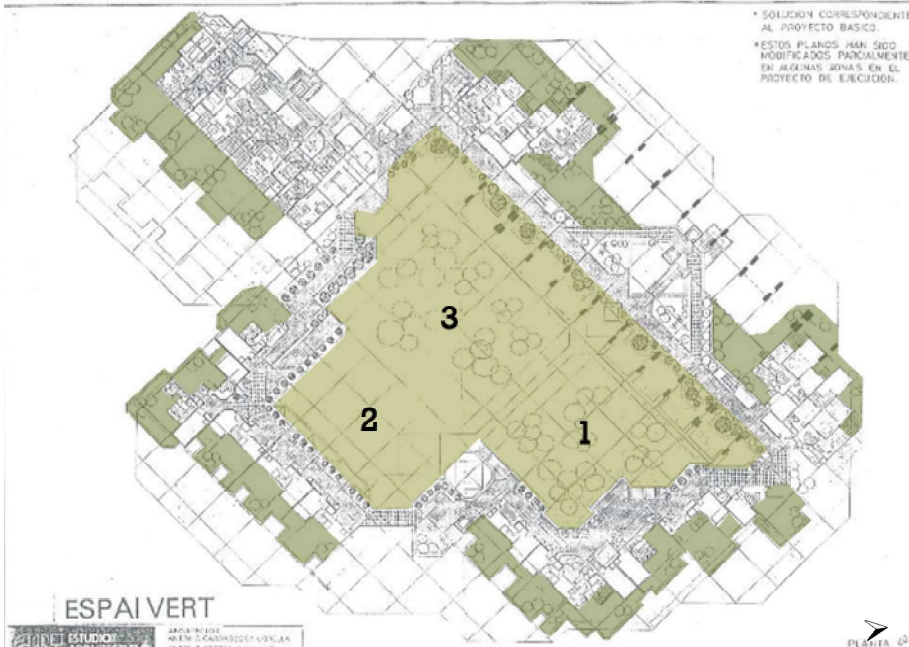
Diagrama de los espacios verdes sobre la Planta baja proyecto básico Espai Verd.
